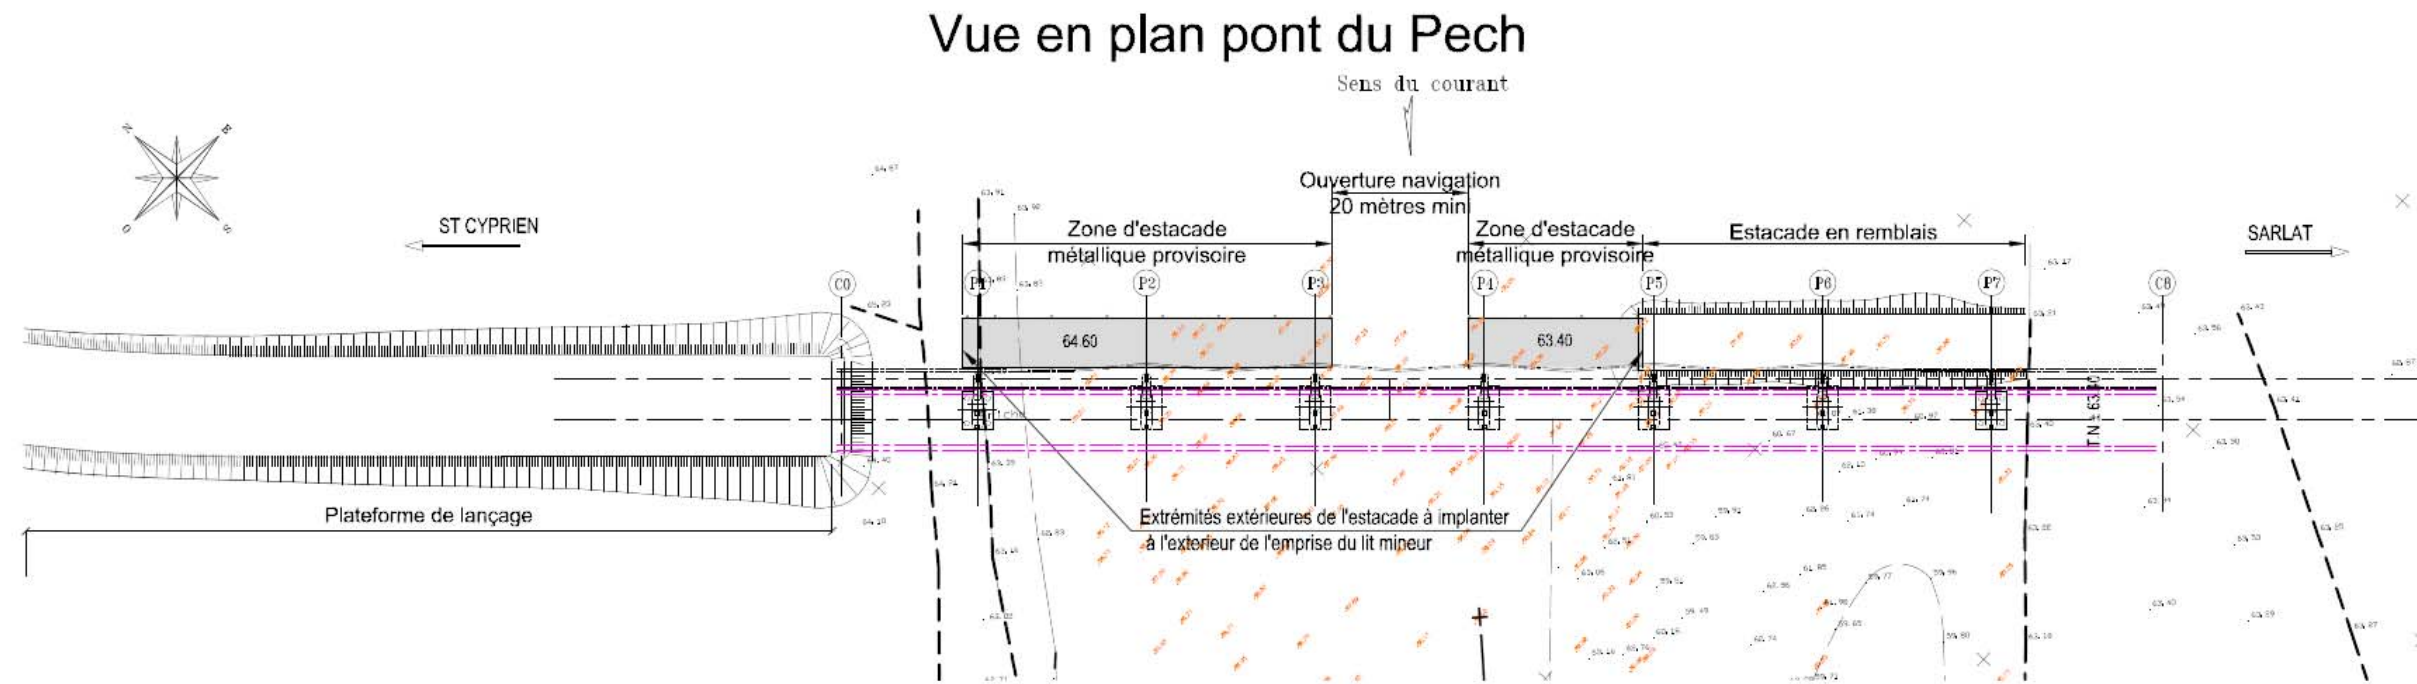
Vue en plan Pont du Pech – Phase travaux (Setec tpi, avril 2017)
